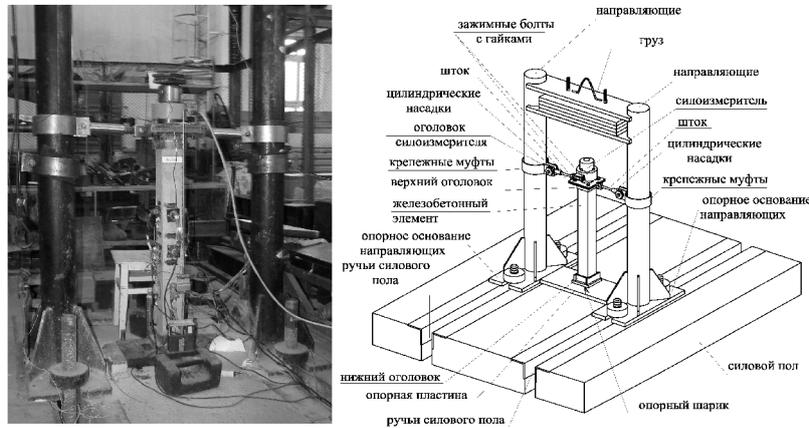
Стенд для испытания железобетонных колонн и их стыков на кратковременную динамическую нагрузку
